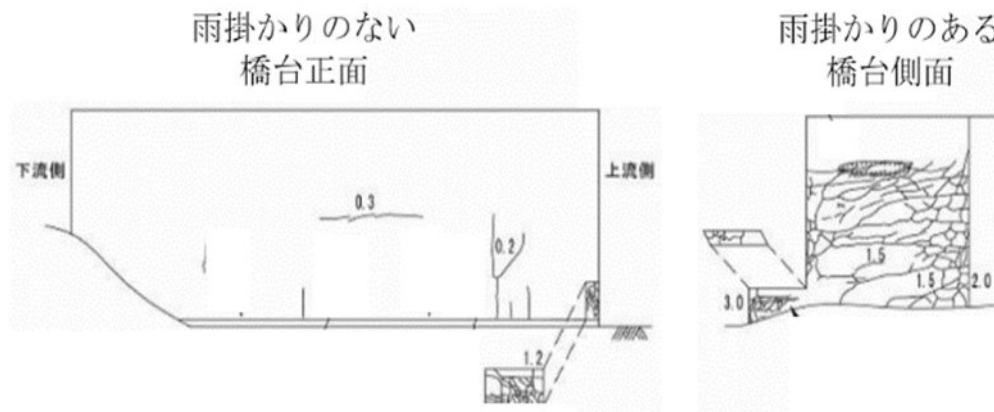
雨掛かりの有無によるひび割れ発生状況の違い
